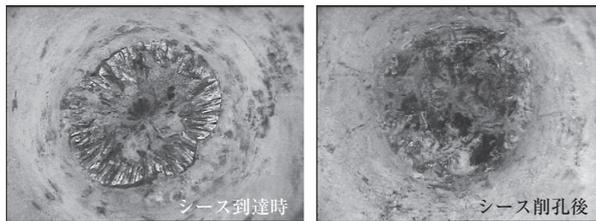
シース管内部状況 (橋軸方向ひび割れ)
